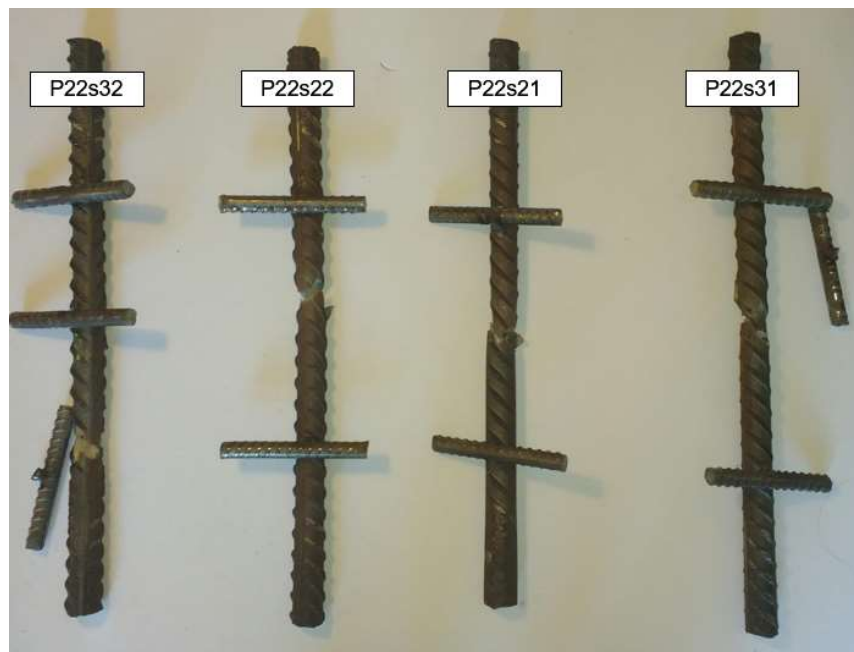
Zona de falla de probetas soldadas de 22 mm.
